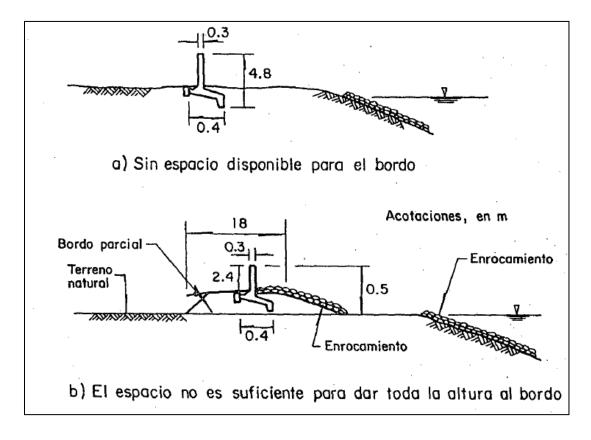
Muro de encauzamiento. (Maza, 1996)
